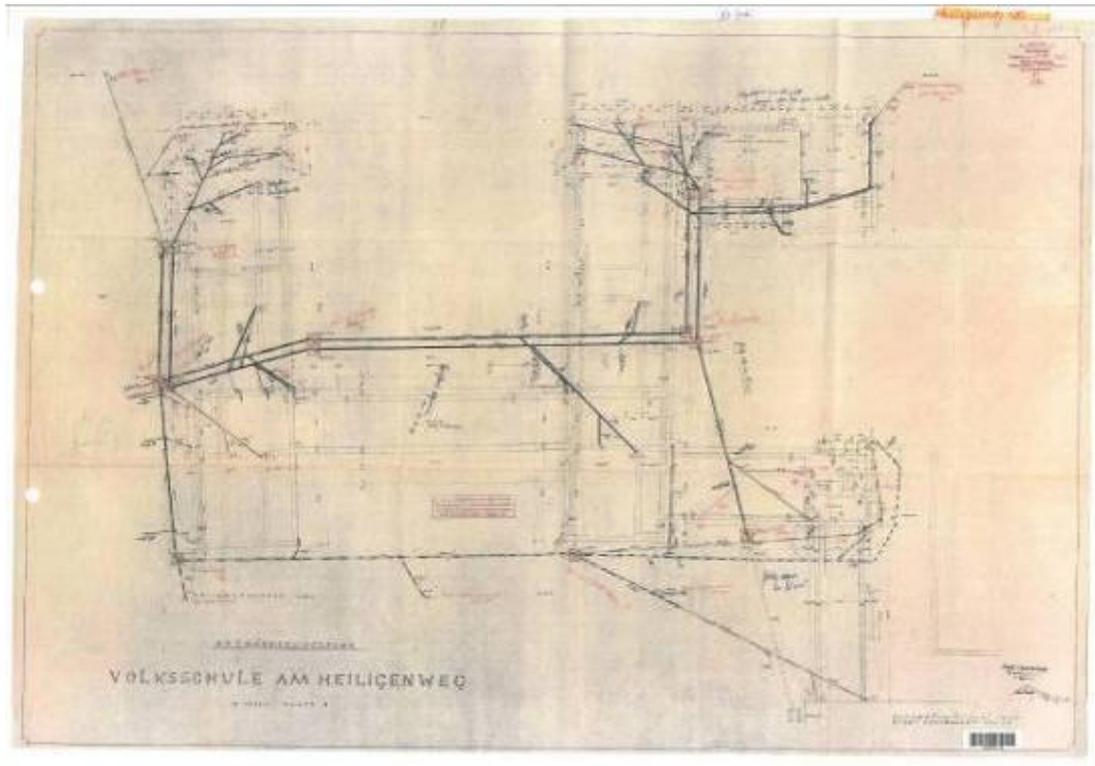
Heiligenwegschule, Osnabrück: Lageplan Turnhalle mit eingezeichnetem Entwässerungsnetz unterhalb der Umkleide- bzw. Sanitärräume (Links).
